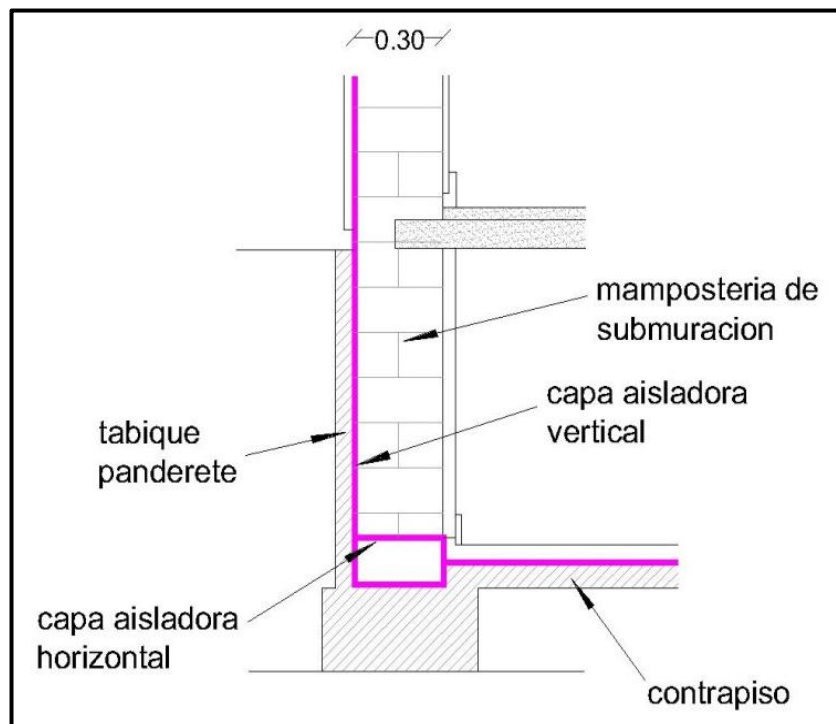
Vista de Muro Divisorio en Sótano
